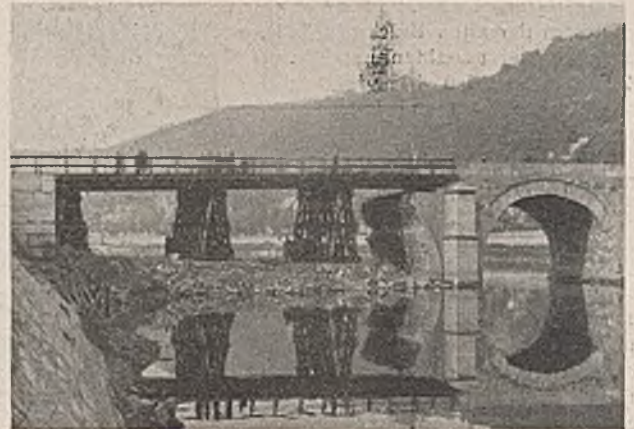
Walzträgerüberbau in der alten Achse. Holzbocke auf Betongrundwerken, die in offener Baugrube hergestellt werden konnten.
